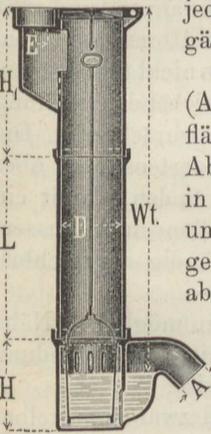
Regenrohrsandfang mit Geruchverschluß. (Nach System Steuernagel.)
